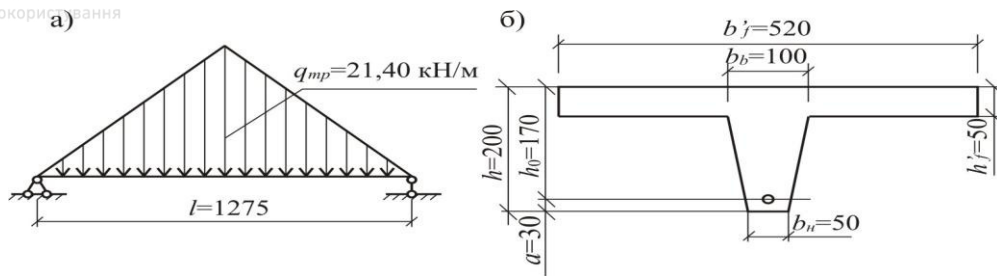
Розрахункова схема (а) і розрахунковий переріз (б) поперечного ребра.
